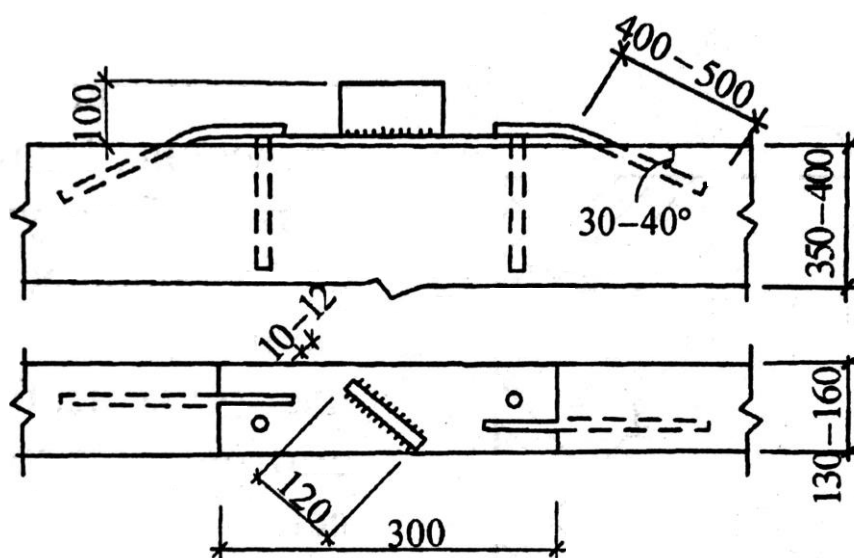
Конструкция анкерной детали для крепления арматуры угловых зон
